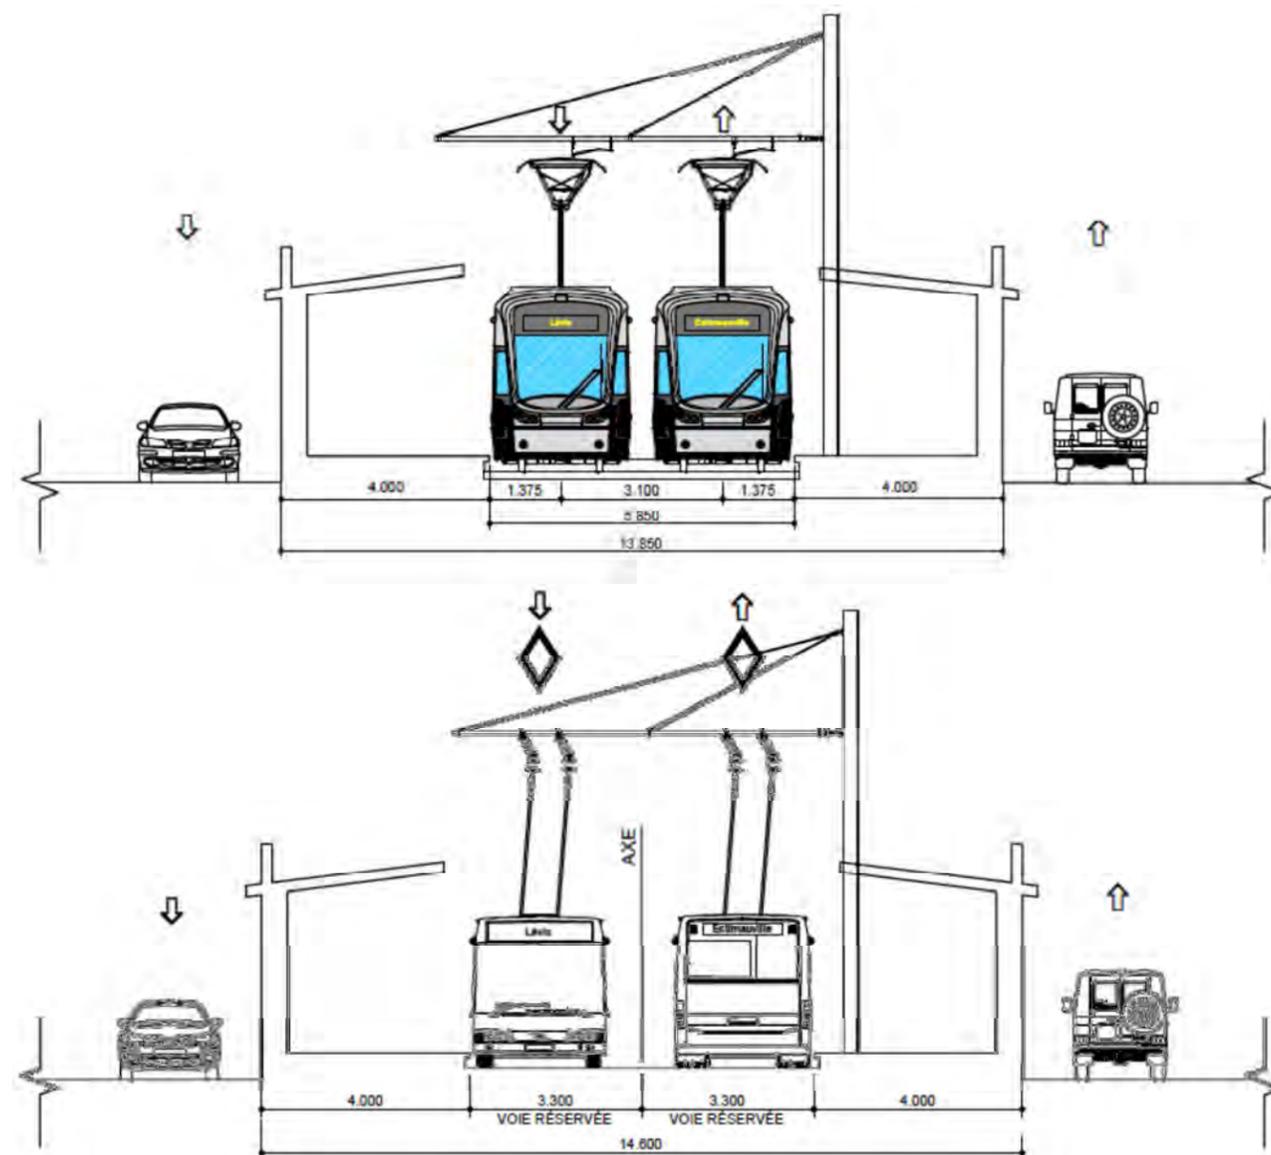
Coupe type 14 de 15 - SRB - Site propre standard - Station avec quais latéraux
